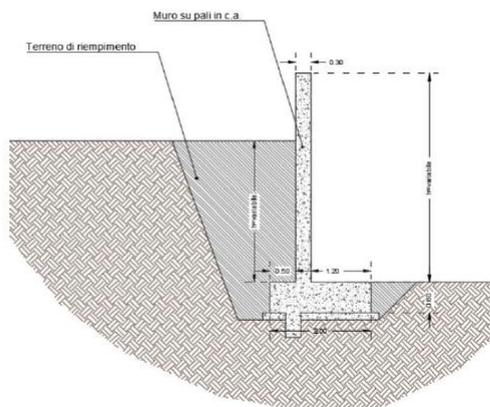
Sezione tipologica muro su pali. Manufatti singolari.
